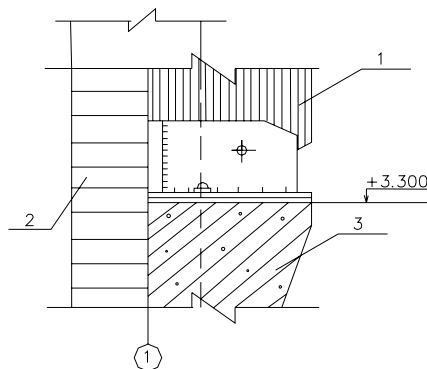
Опорний вузол: 1 – вигнуто клеєна дерев'яна рама, 2 – цегляна стіна, 3 - консоль монолітного ростверку фундаменту
